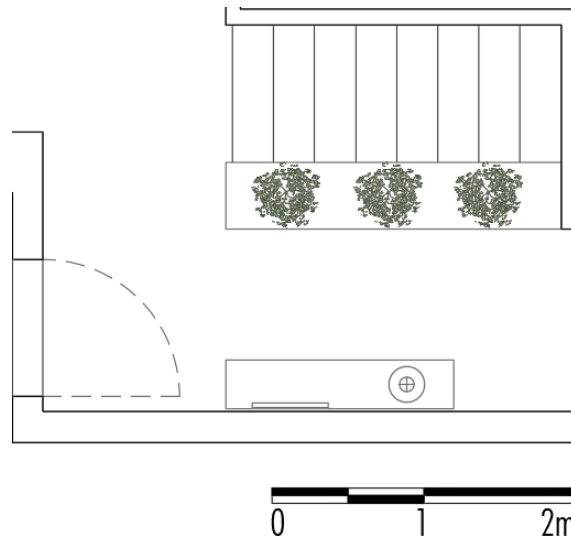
Planta proposta final do hall de entrada (Fonte: Autora, 2023)
